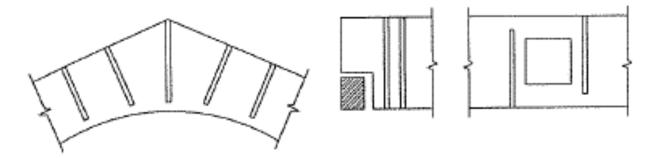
Barras encoladas como armadura frente a la tracción perpendicular.
